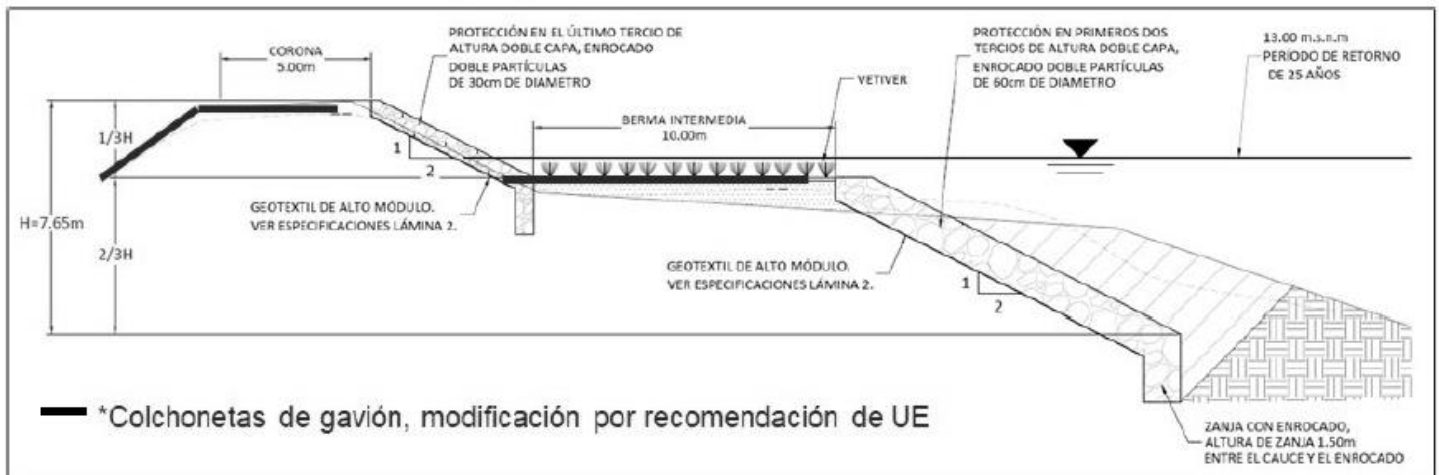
Sección típica de obras de protección en Zona B. Elaborado por Grupo Acón y modificado por CORBANA, 2019.
